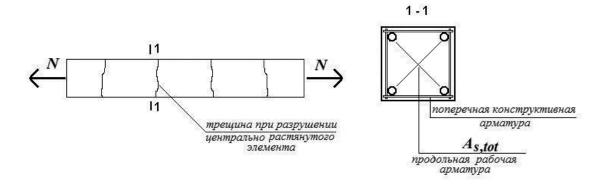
Армирование (сечение 1—1) и трещины при разрушении центрально растянутого железобетонного элемента
